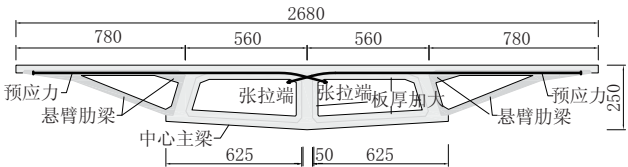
引桥混凝土脊骨梁的断面图及预应力布置(单位:cm)
